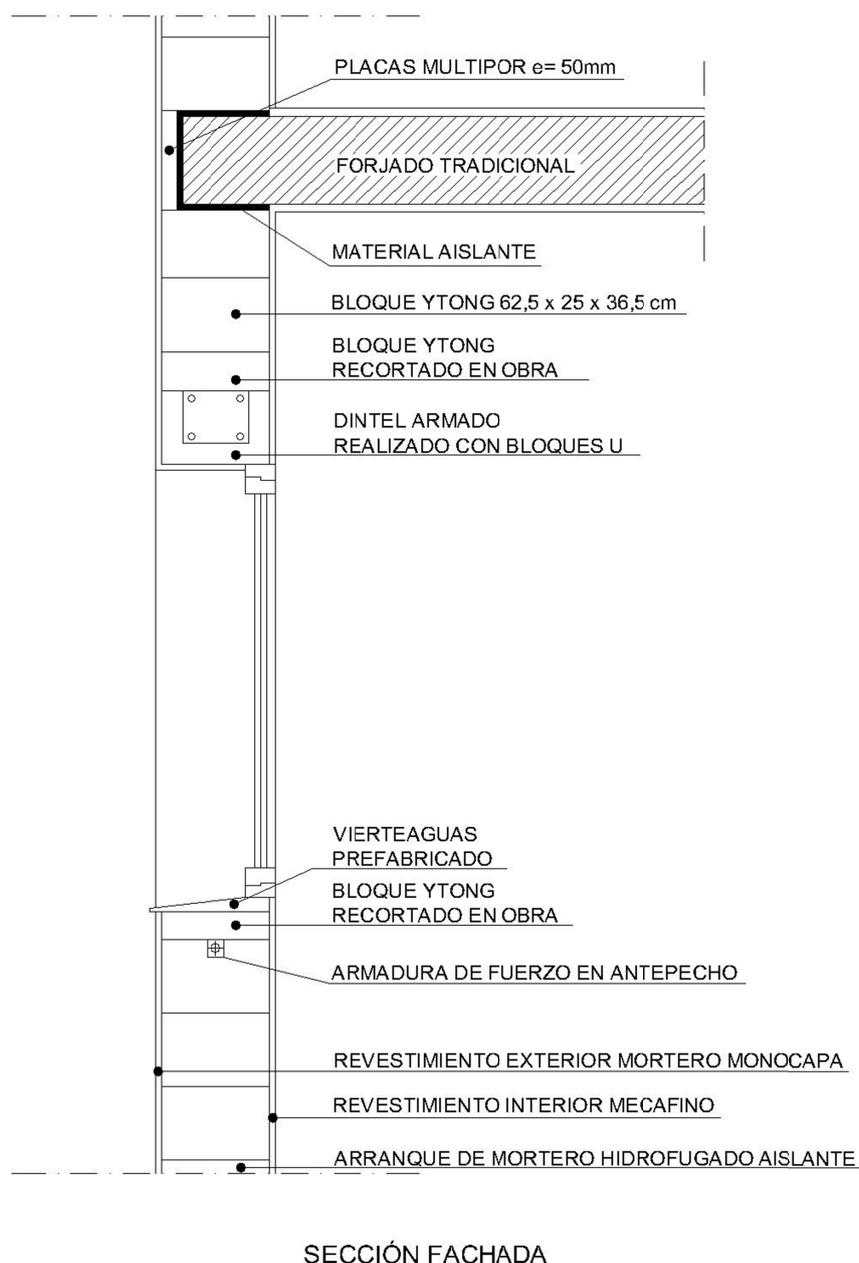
Detalle sección fachada con bloques Ytong
